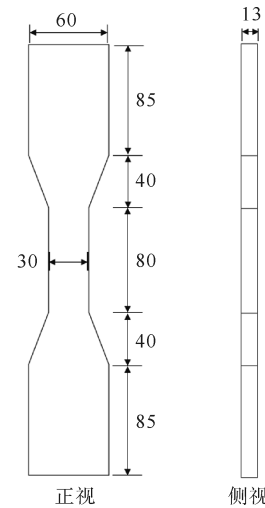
ECC 狗骨头试块的尺寸(单位:mm)
